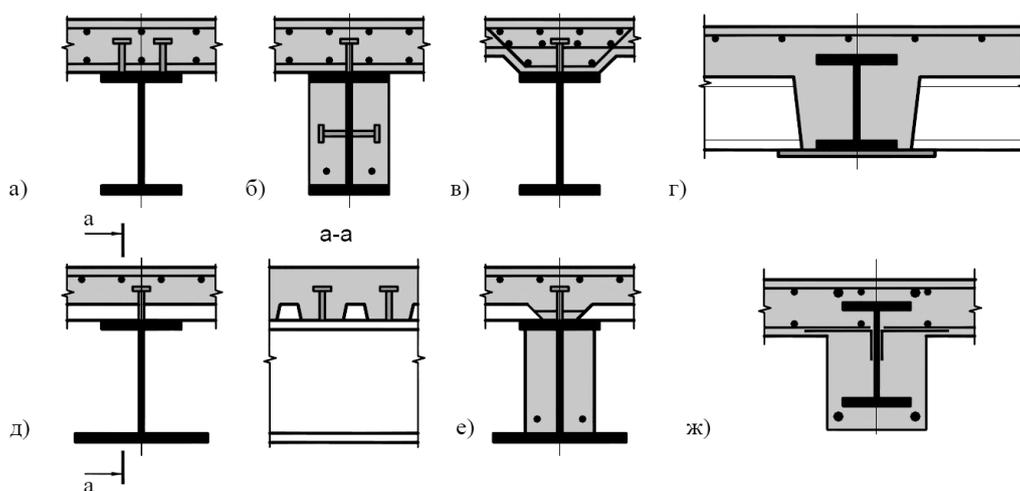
Стальные балки, комбинированные с монолитной железобетонной плитой
